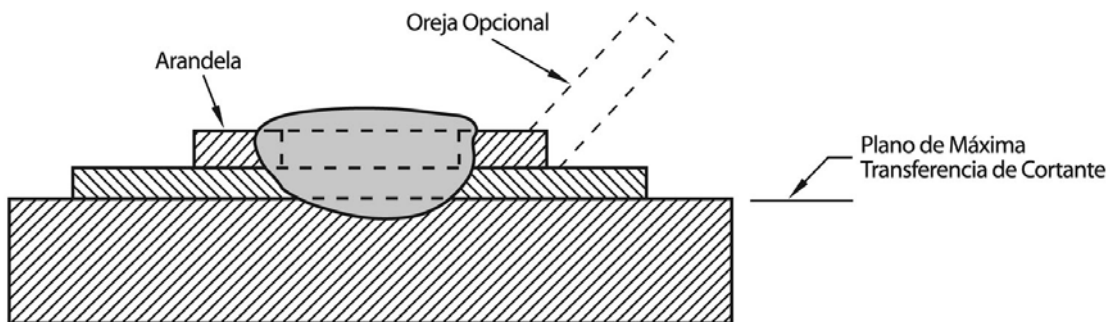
Soldadura de tapón con arandela
